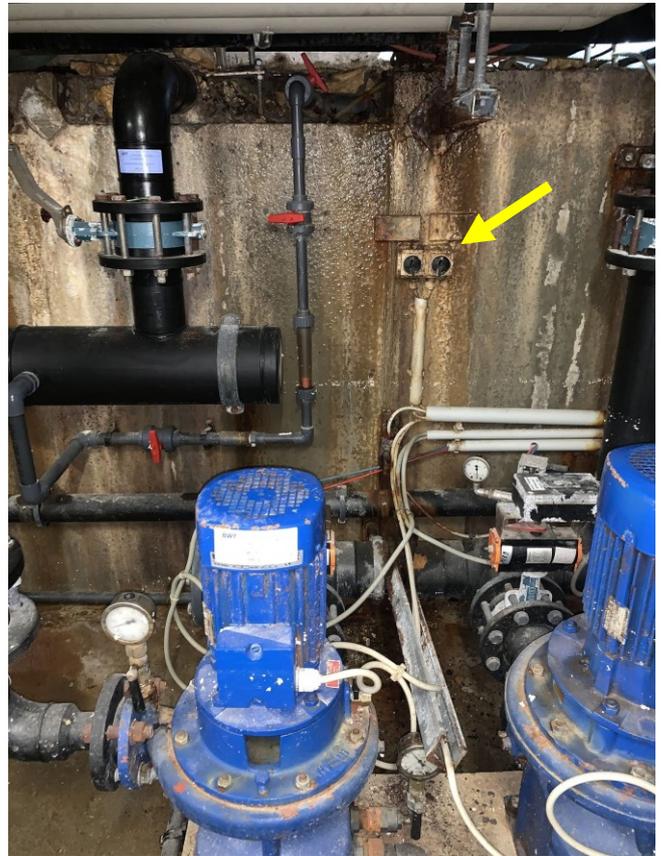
Wasser läuft über Wand und Stromanschluss und steht am Boden
